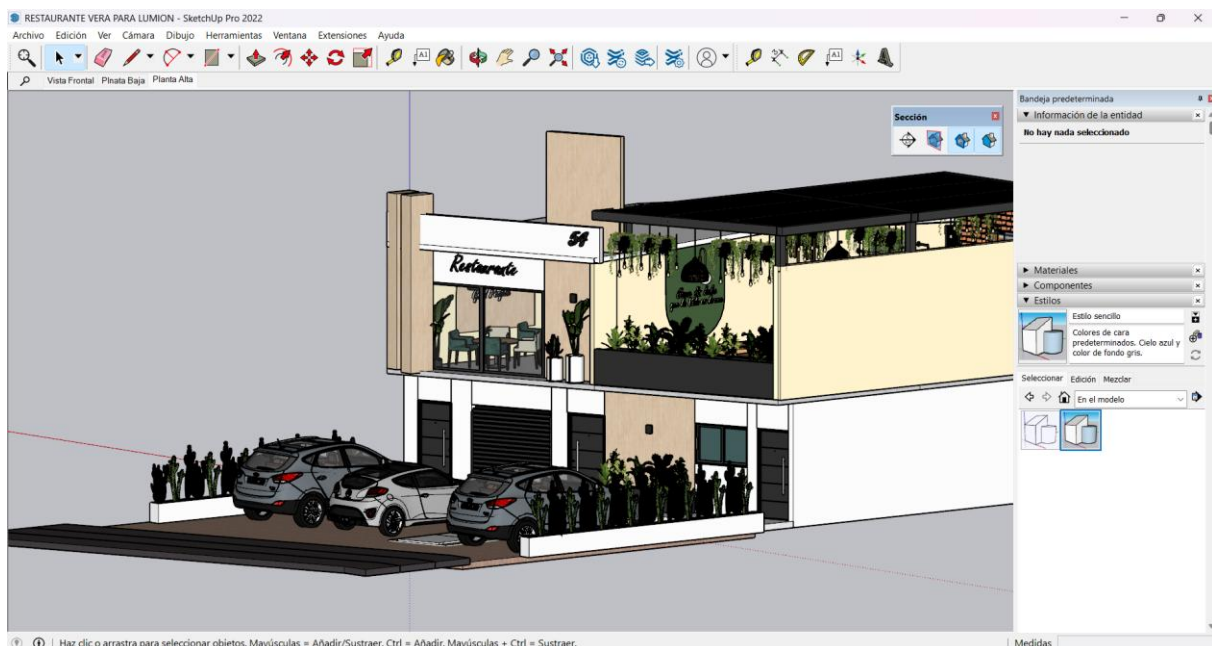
Modelado de restaurante mediante SketchUp. Nota. Elaboración propia
